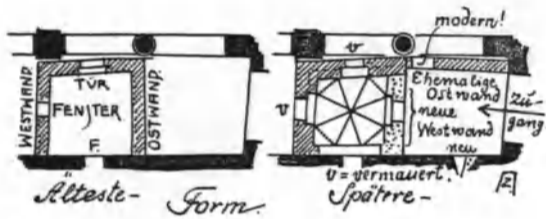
Ursprüngliche und spätere Form des Grundrisses.
